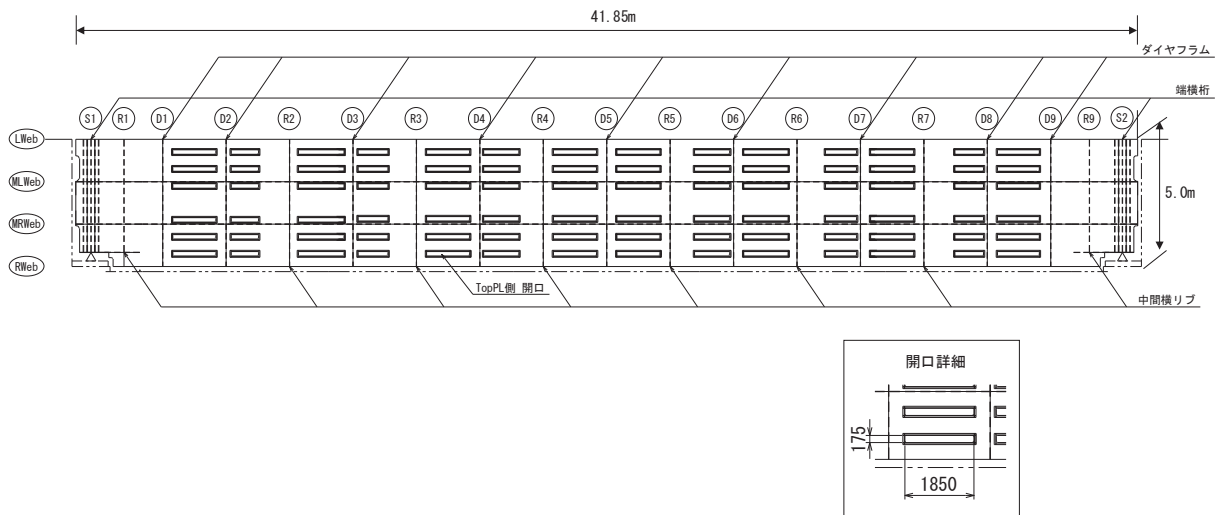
(2) 鋼製遮水壁 (鋼桁 1) 平面図
